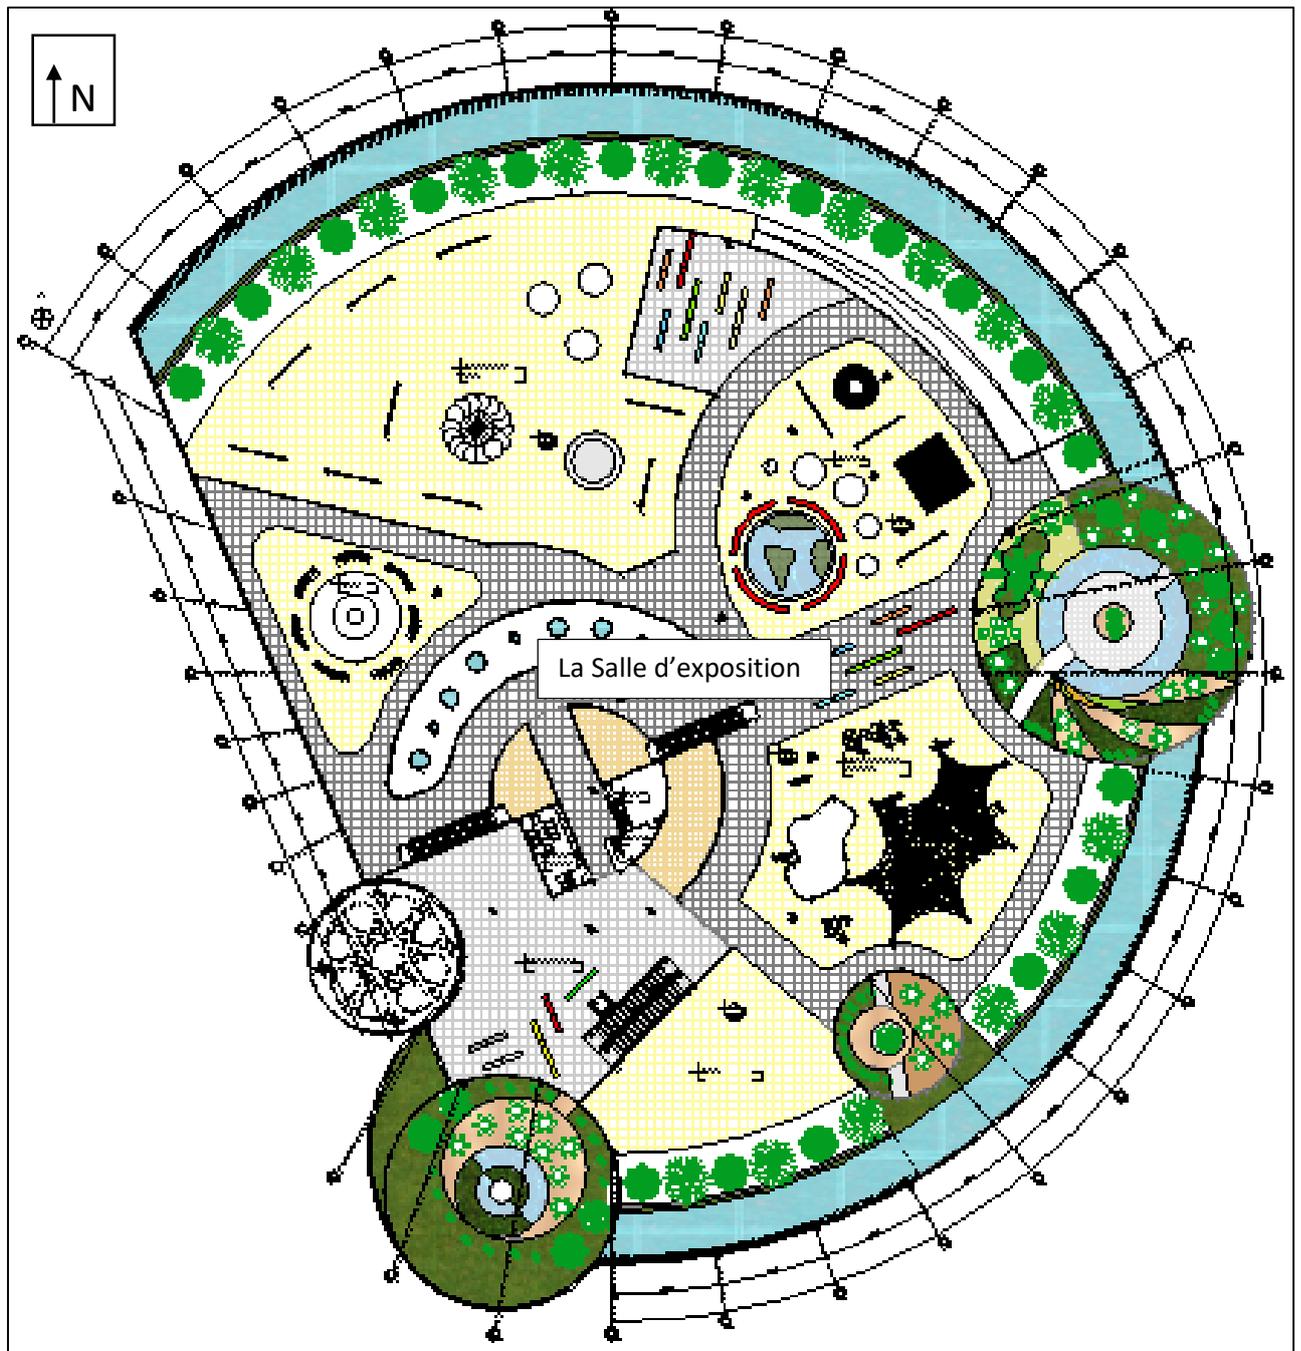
Le plan de centre des expositions 2<sup>ème</sup> étage (source : auteur).
